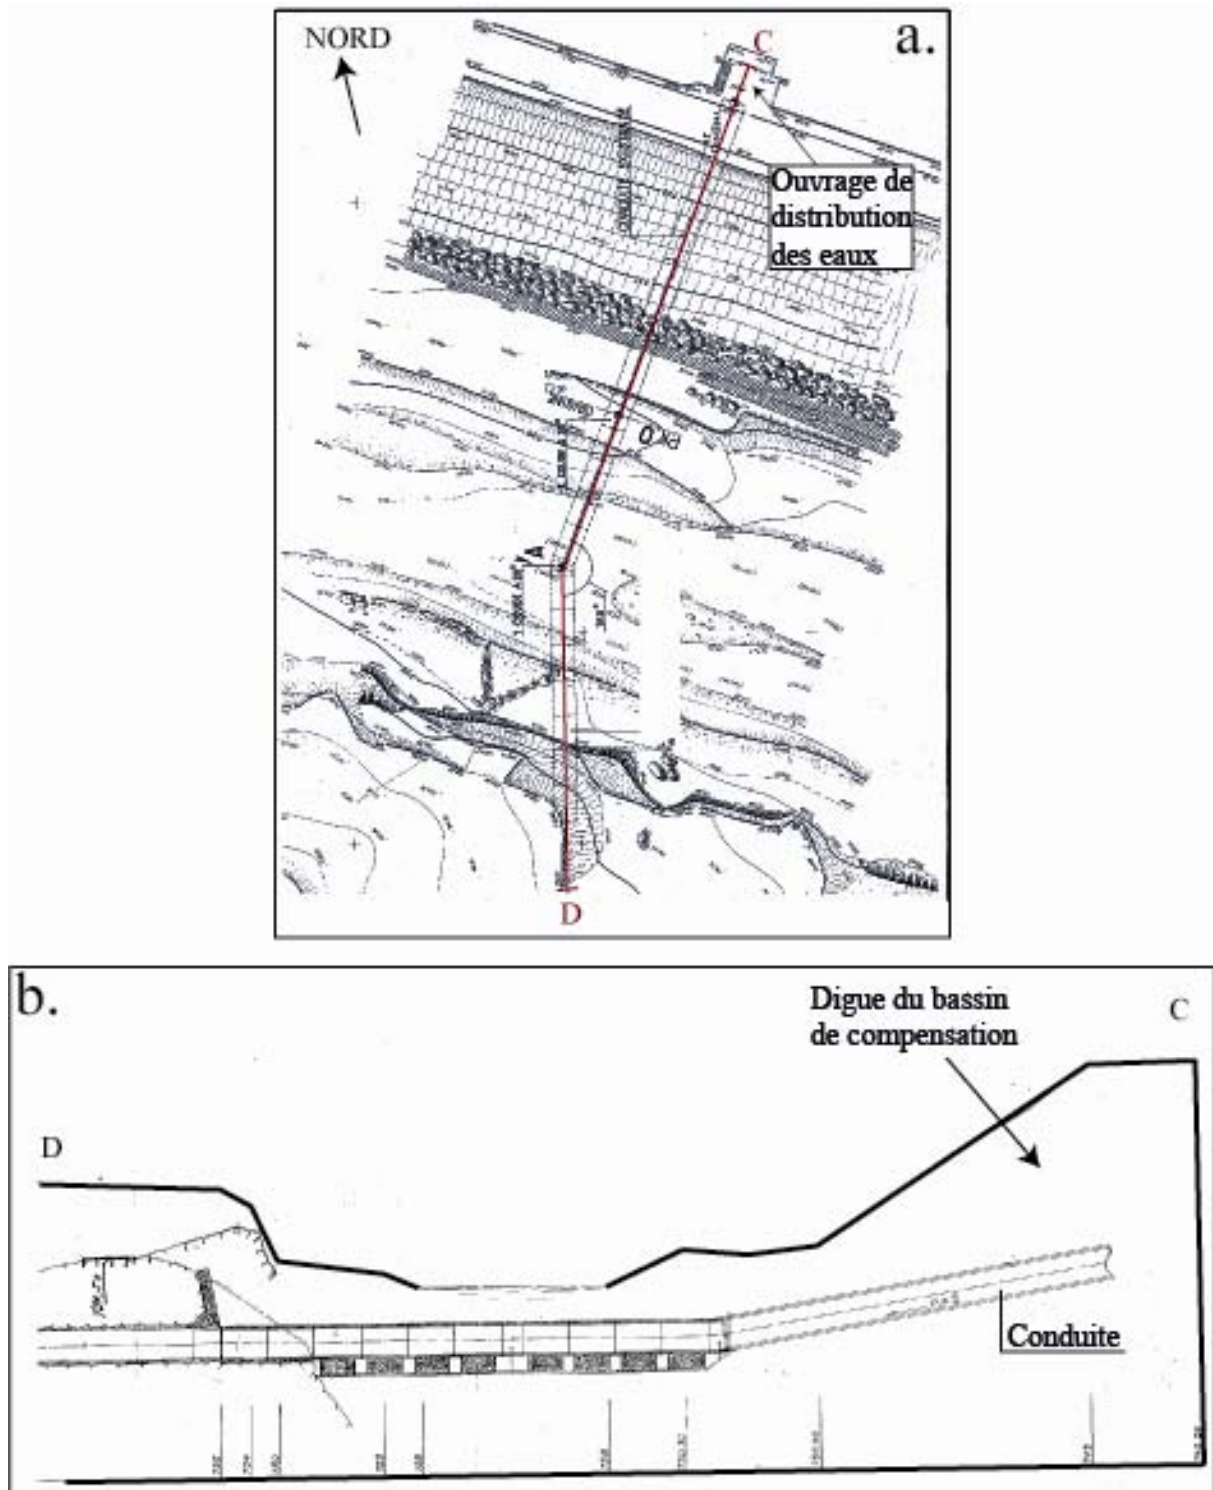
a. Vue en plan du passage de la conduite sous l'ouvrage. b. Vue en coupe du passage de la conduite le long du profil CD.
